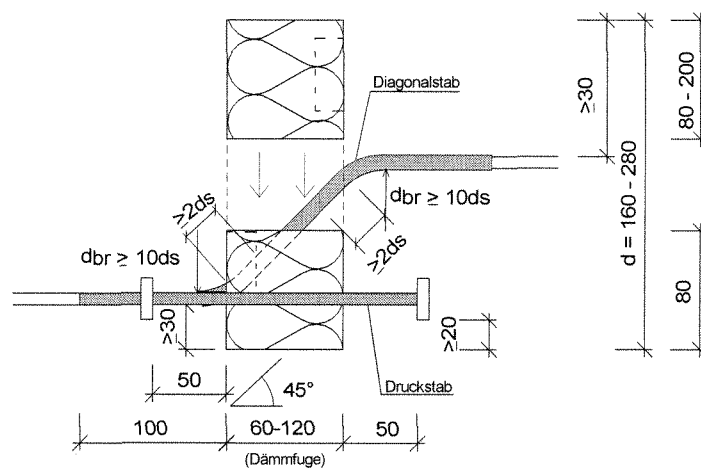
egcobox Plattenelement Typ PV-DD-F
